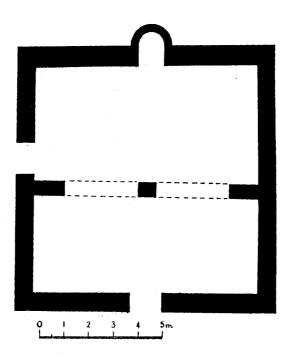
مسقط أفقي للجامع الأقصي الحالي . (عن : كريزول) .
